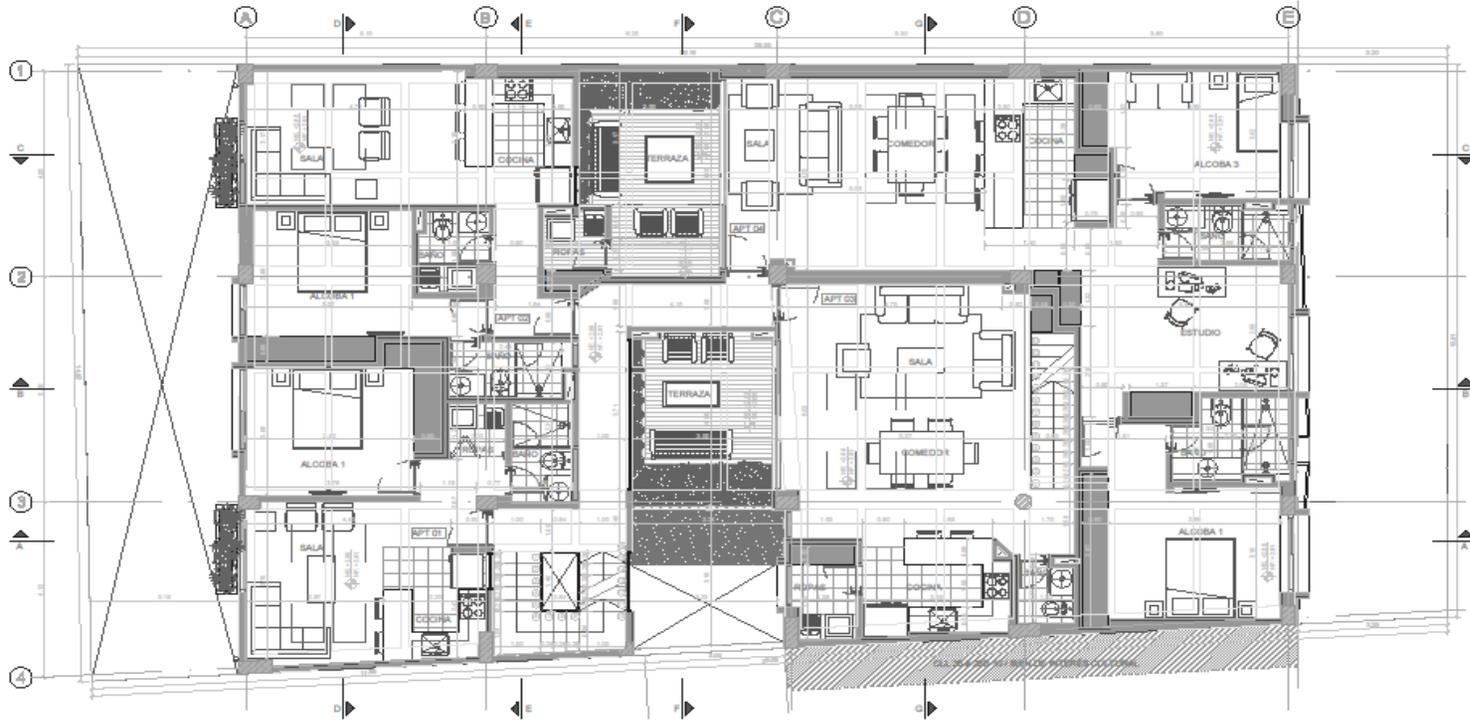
Plano arquitectónico tercer piso. Fuente Arq. Alexander Palacio.
